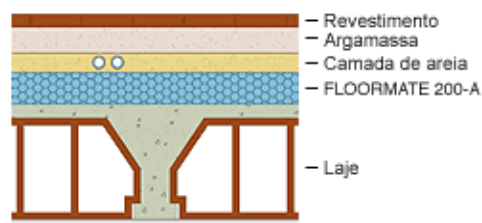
Isolante aplicado sobre laje ou soleira [30]
